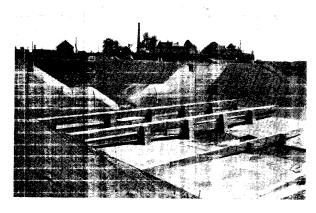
Mündungsbauwerk. Im Vordergrund Tosbecken mit Wasserbremsen.
